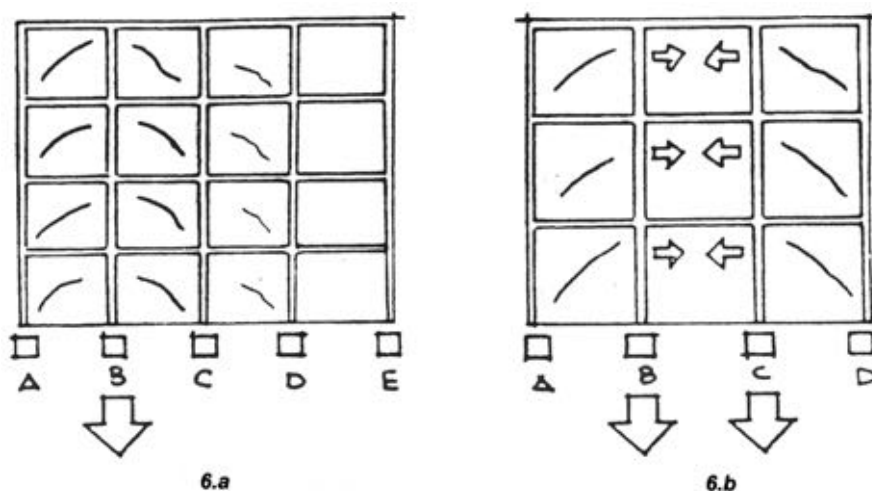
FISURAS EN MARCOS POR CEDIMIENTO DE ELEMENTOS
